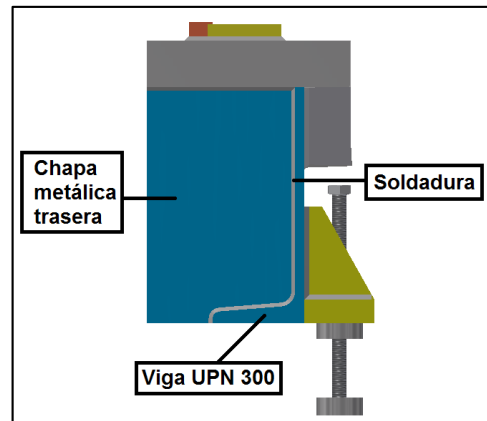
4 Detalle de la soldadura entre la chapa metálica y la viga UPN 300
